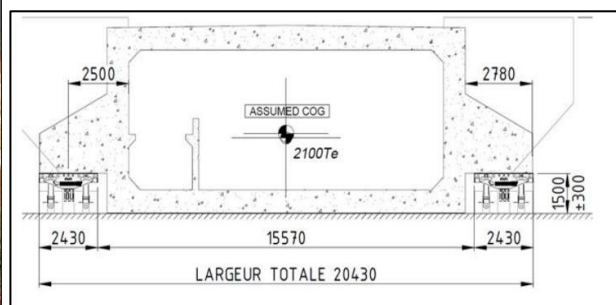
Mise en place d'un cadre avec corbeaux béton ajoutés aux piédroits
